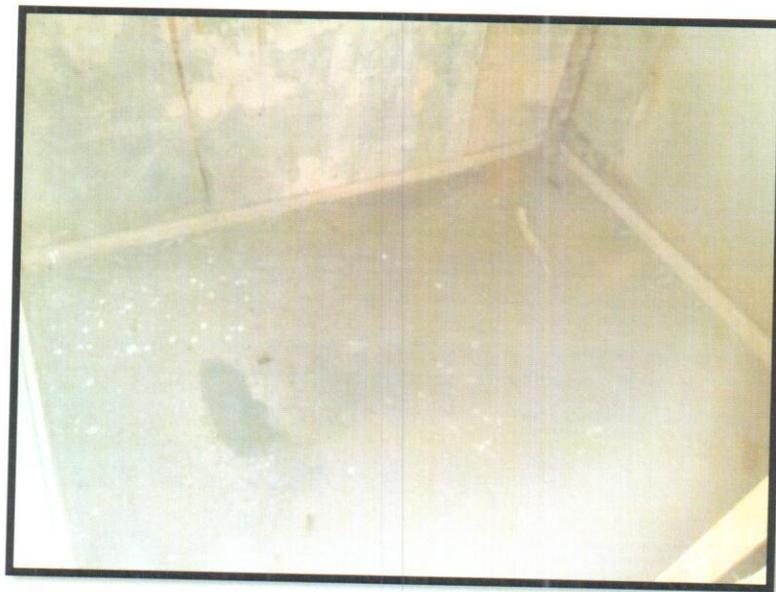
Forma da viga ligeiramente desnivelada.
